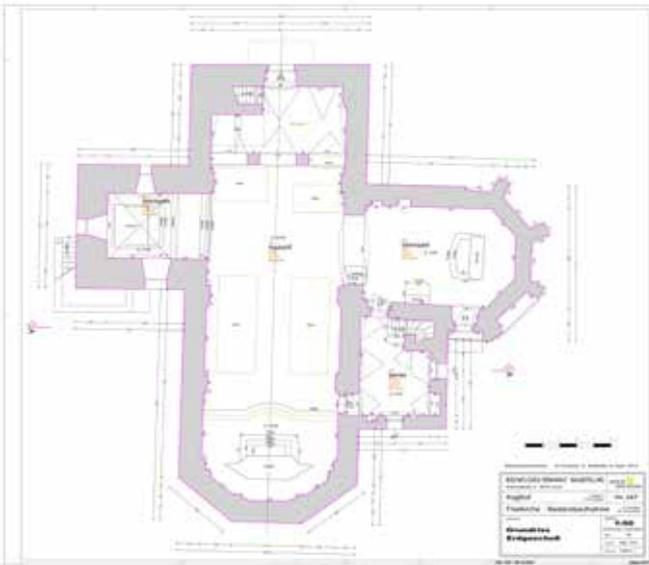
St. Georgen am Gasenbach, Grundrissplan Erdgeschoß
